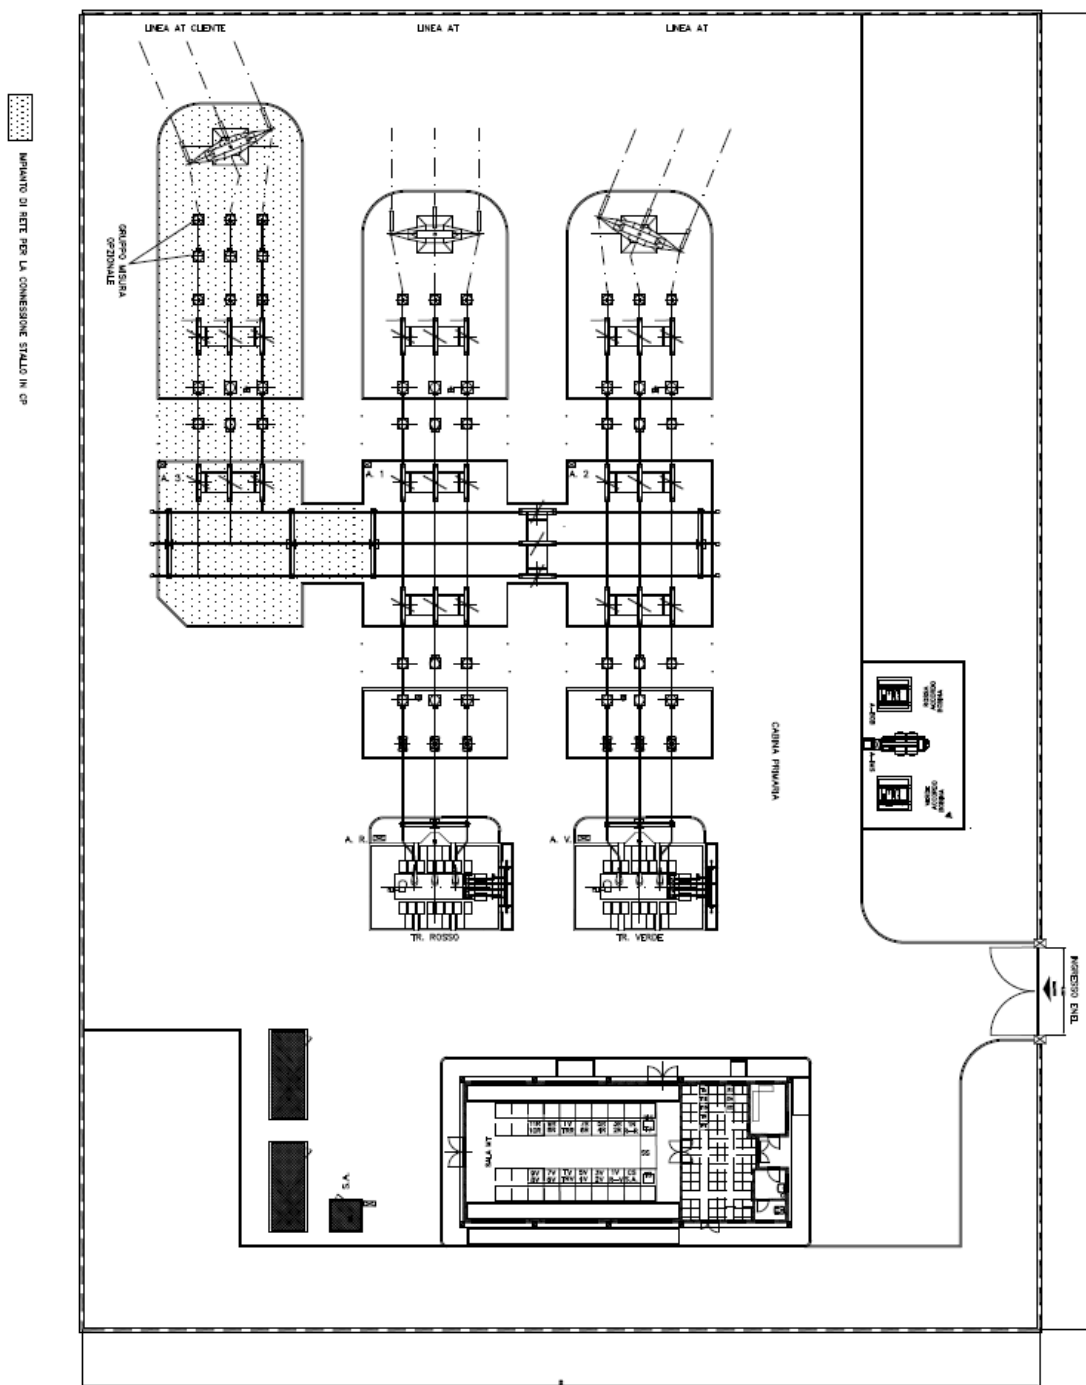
Impianto di rete per la connessione stallo in Cabina Primaria per Cliente Attivo distante da Cabina Primaria (Vista in pianta).
